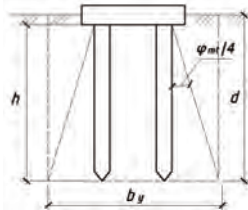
Схема к расчету осадки фундамента по СНиП 2.02.01 - 83
